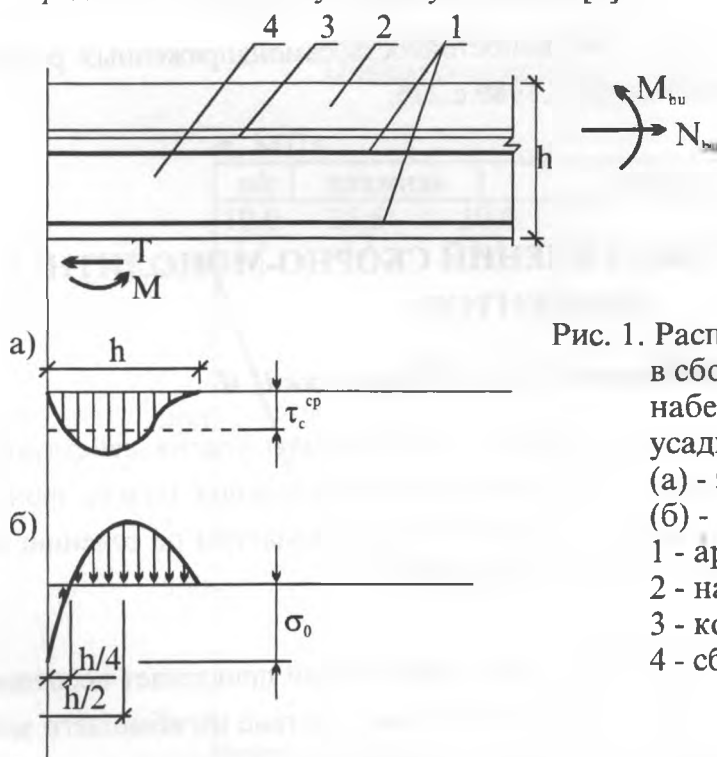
Распределение сдвигающих усилий в сборно-монолитном элементе с набетонкой из бетона на ПЦ от усадки:
